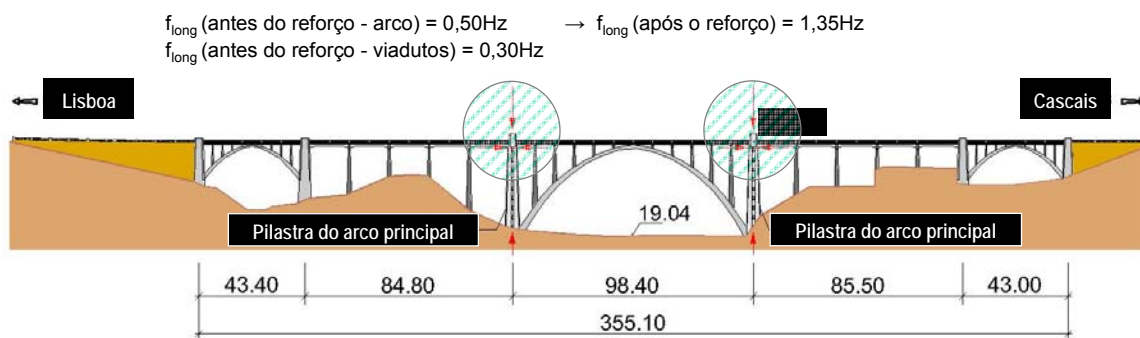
Concepção do projecto de reforço (ainda não executado)
